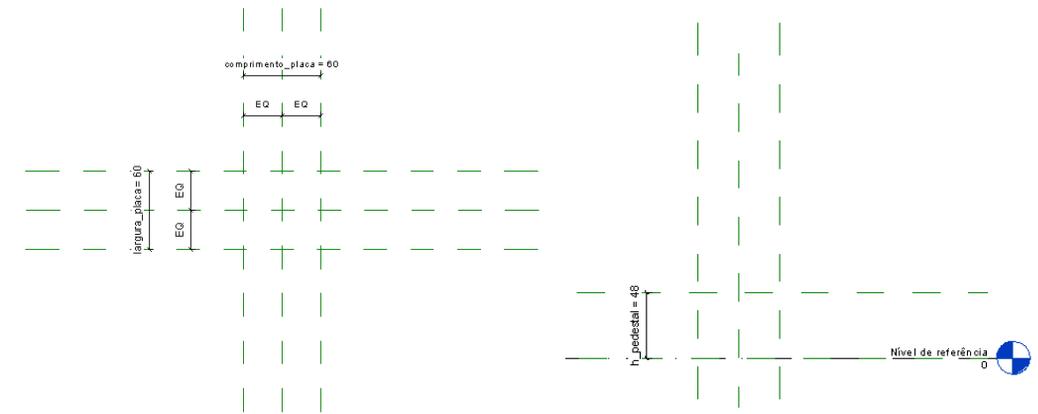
Planos de Referência em planta e em corte, respectivamente.
